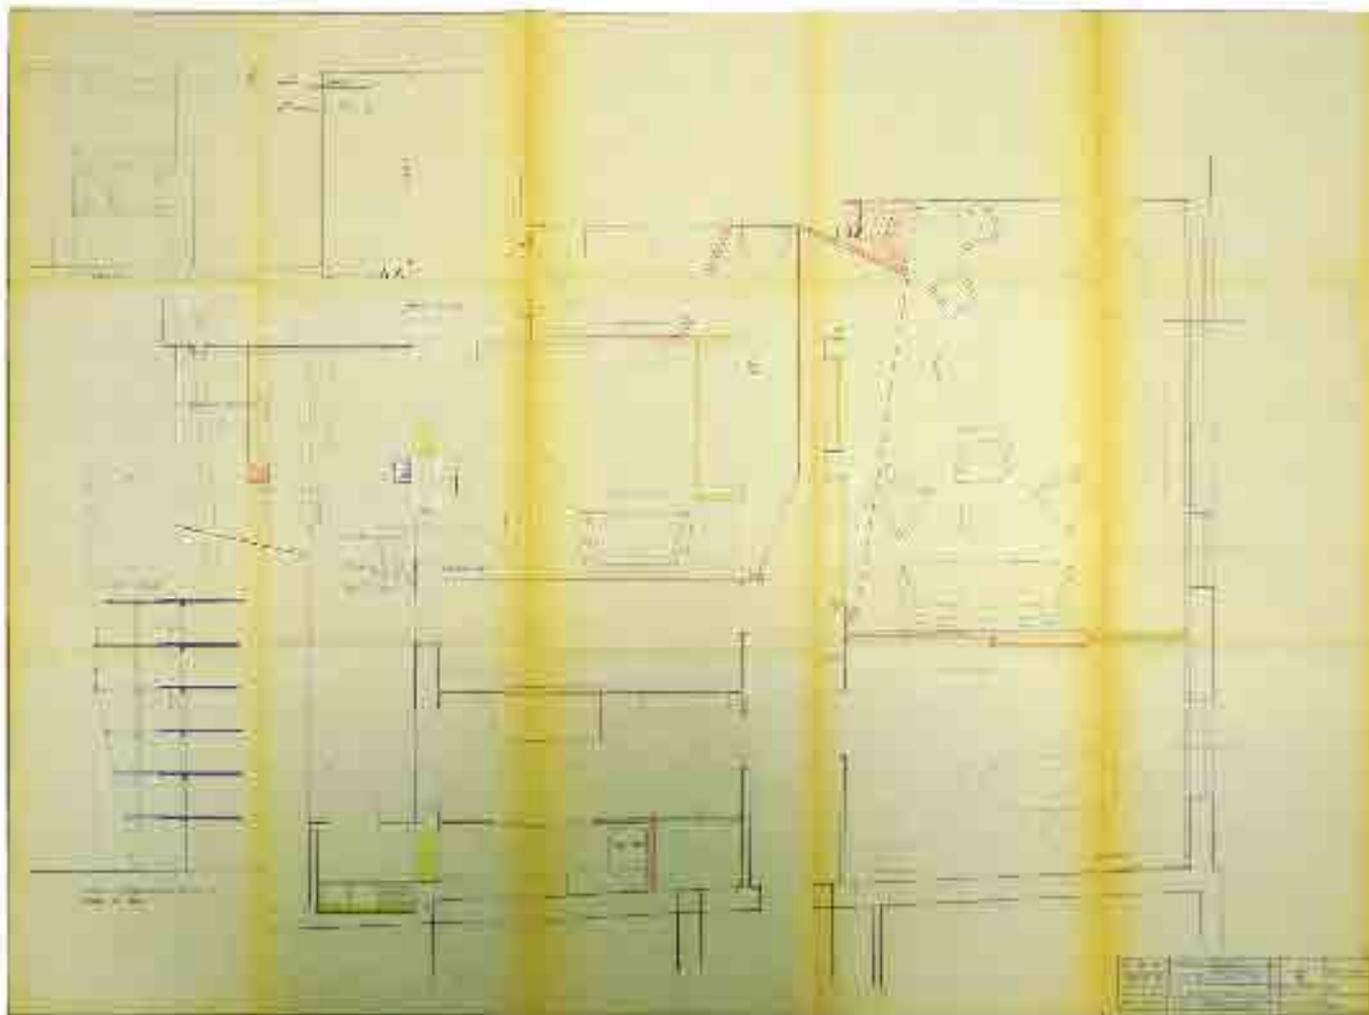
P. Bottoni, Planimetria del progetto di sistemazione e arredamento di casa Bissi (1964)
